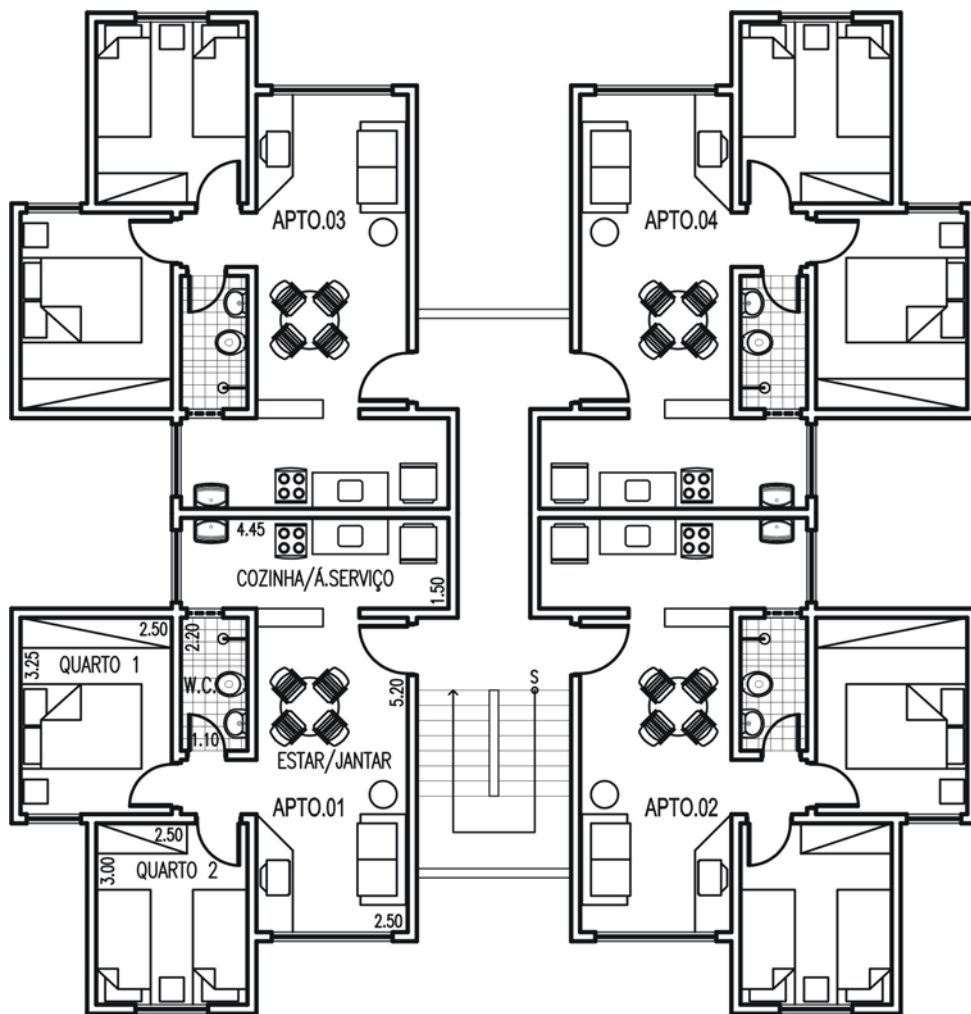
Planta baixa do pavimento tipo do Conjunto Solar do Bosque
